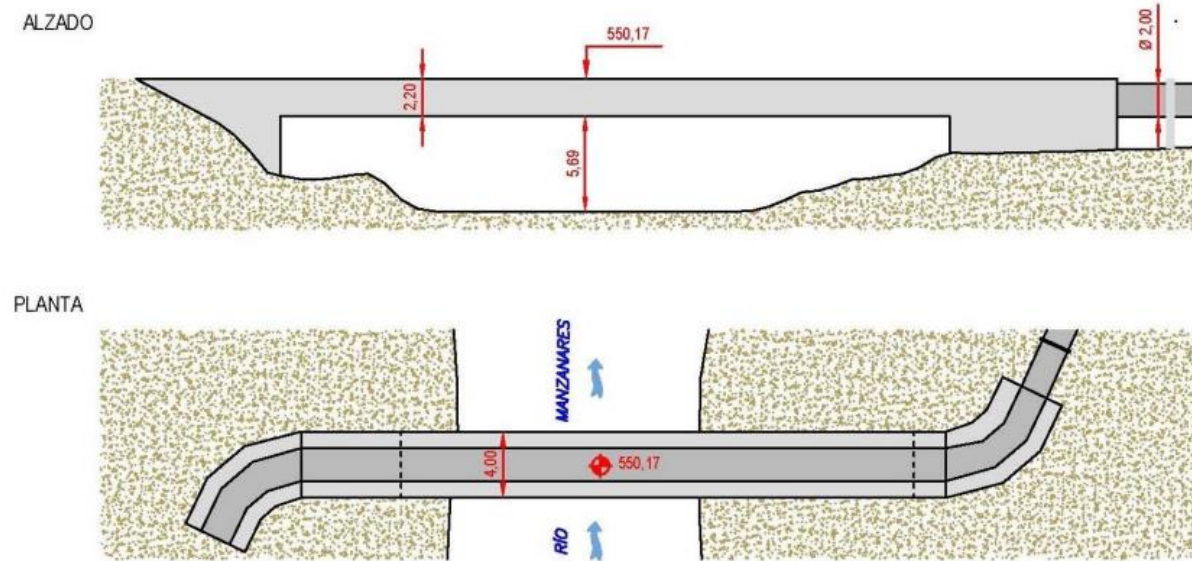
Croquis del cruce de tubería de la EDAR Sur (2011)
